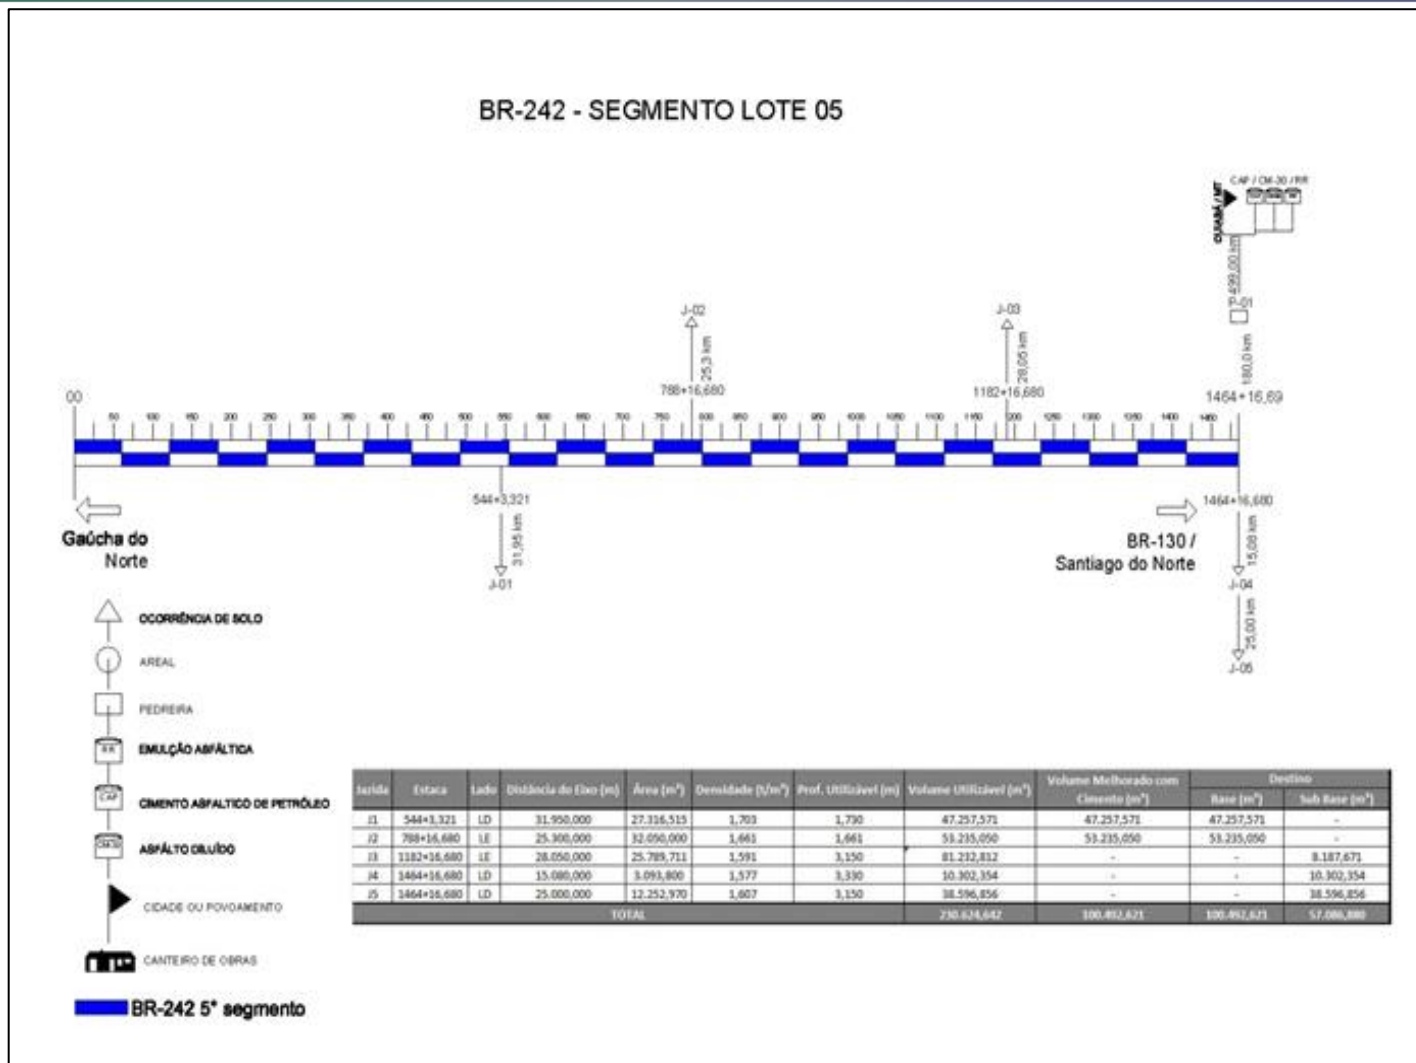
Diagrama da localização das fontes de materiais para a pavimentação e as instalações industriais (Segmento A – lote 05).
